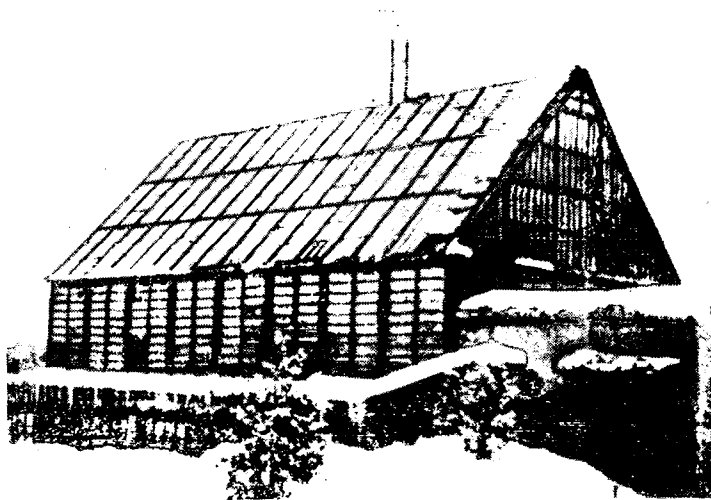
Камера ускоренных испытаний с теплоулавливающими стенами и кровлей
